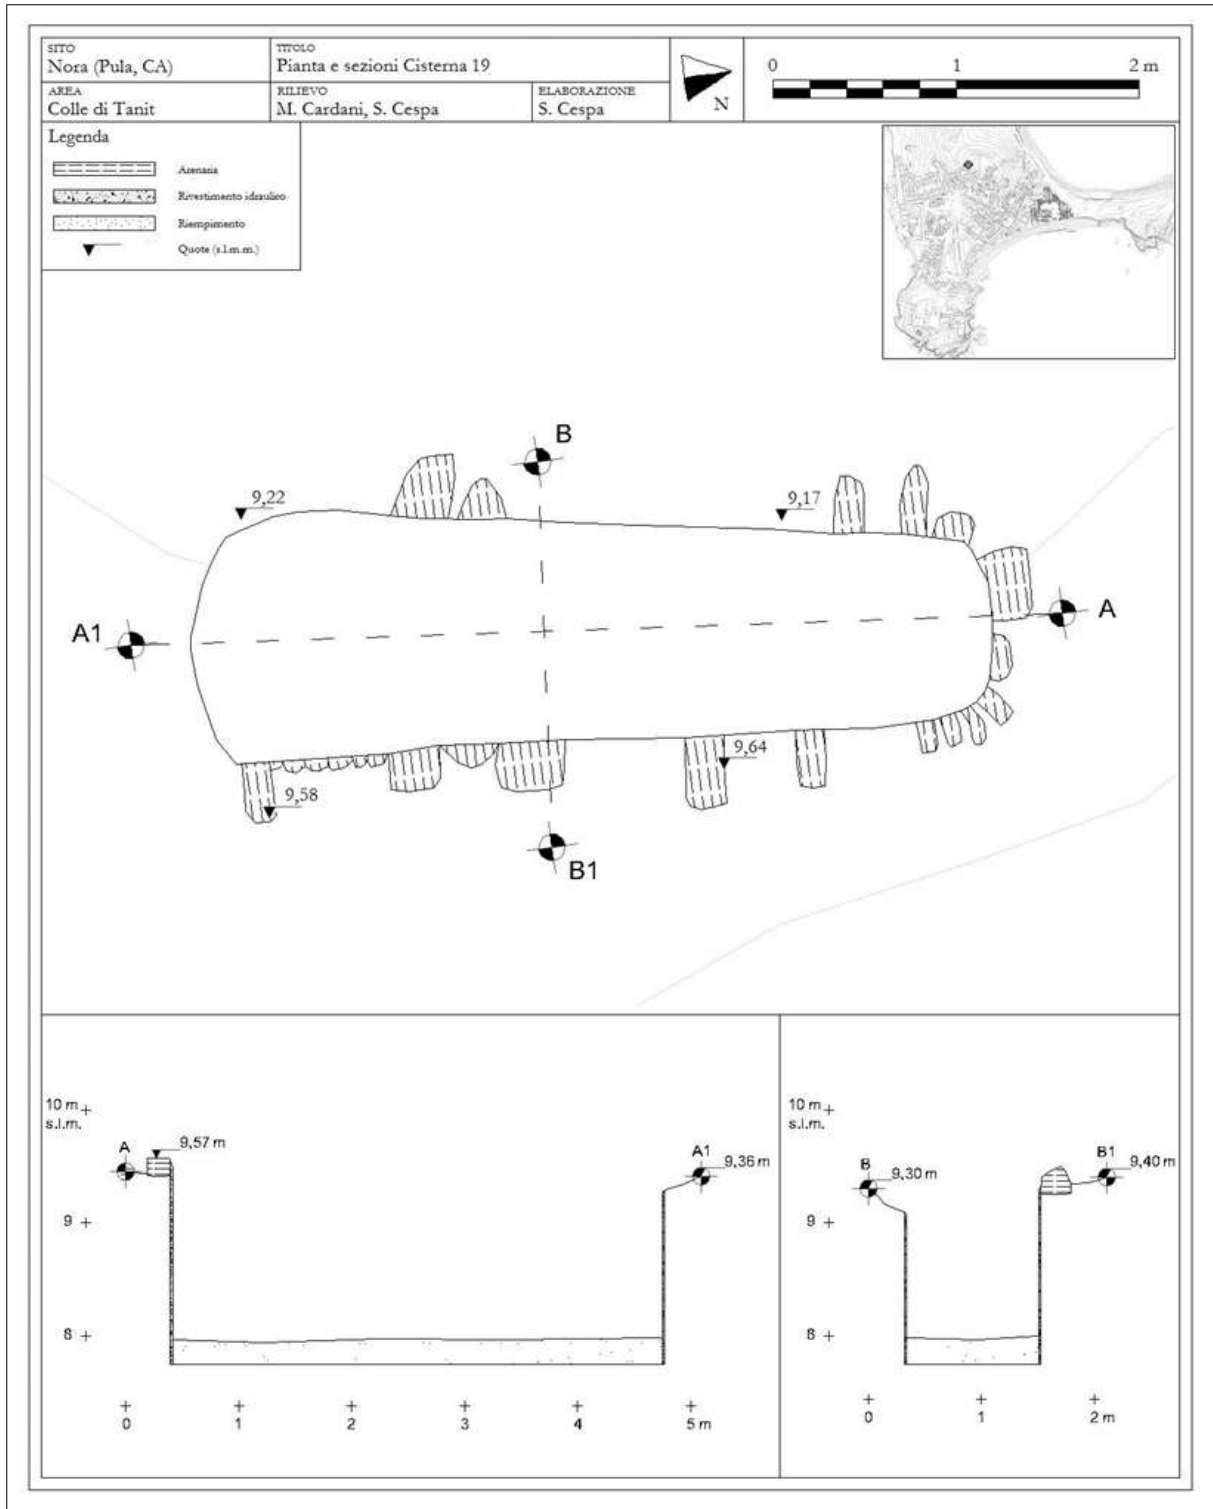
Pianta e sezioni della cisterna 19 (elaborazione dell'autore).
